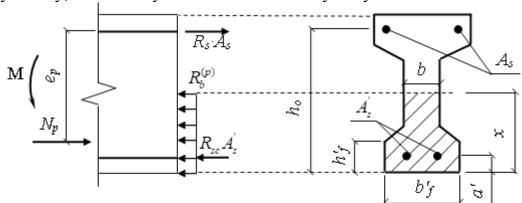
Схема усилий в поперечном сечении железобетонного элемента с полкой в сжатой зоне в стадии предварительного обжатия
